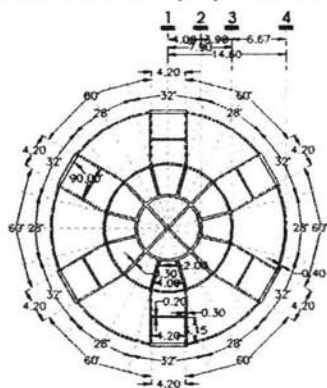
Disposición de los elementos estructurales por piso en la torre PISO 29 y 30.
